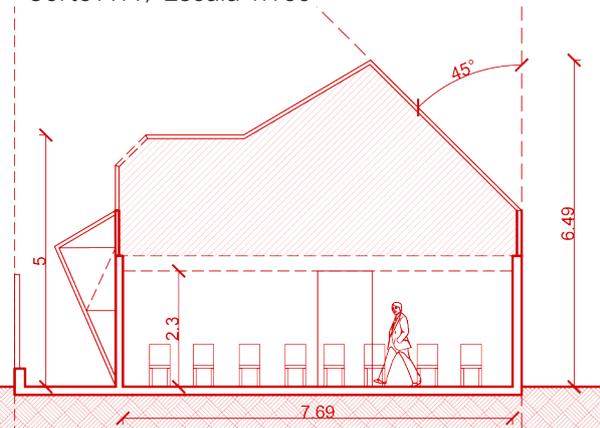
Planimetría Propuesta, lugar de culto. Caso 02
